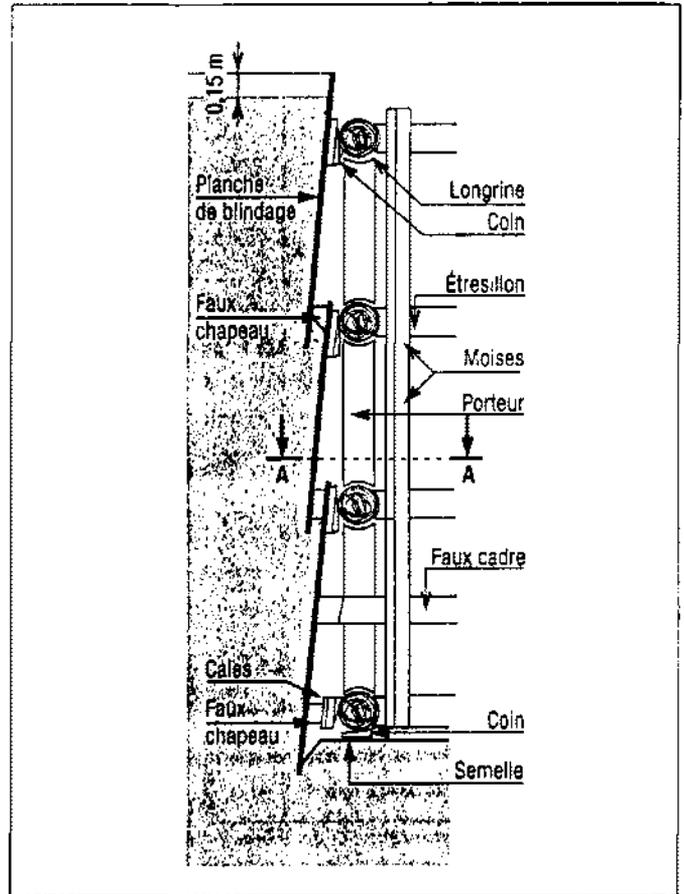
Coupe verticale C.C. (repérée figure 10).
